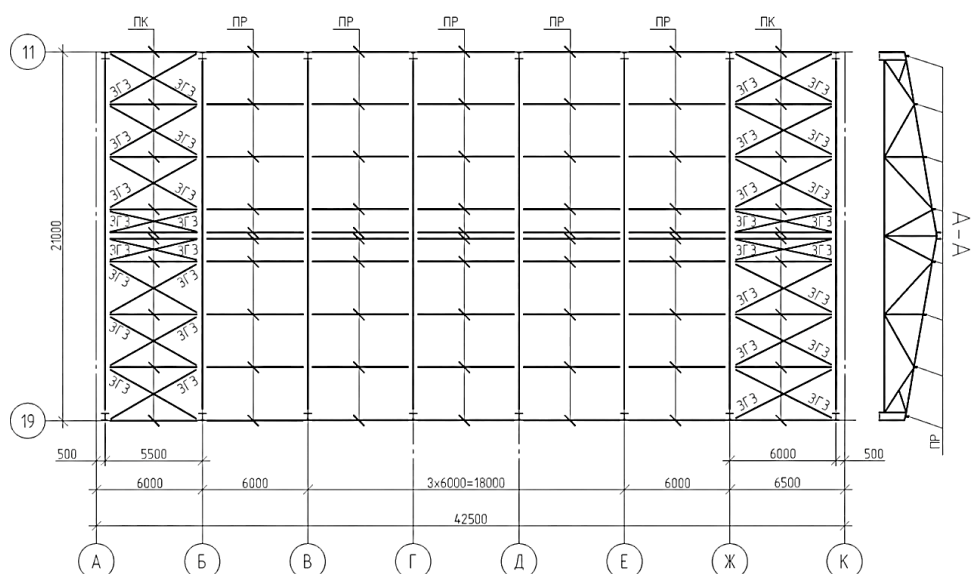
Схема розташування горизонтальних зв'язків по верхніх поясах ферм
